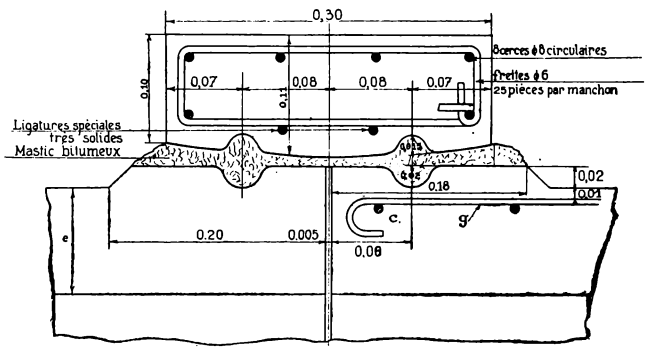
Assemblage par manchon de tuyaux de conduite en béton armé.
